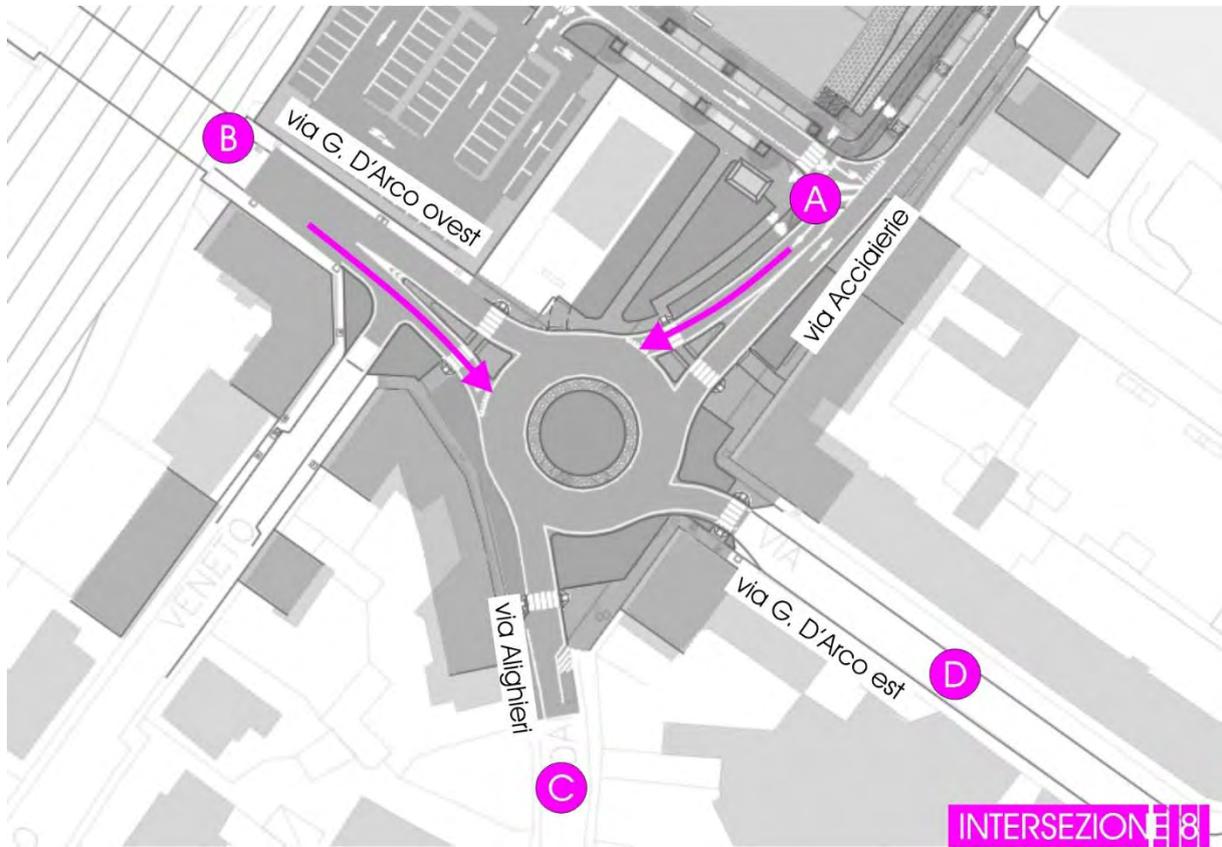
Scenario di Intervento 1 – Planimetria intersezione 8
